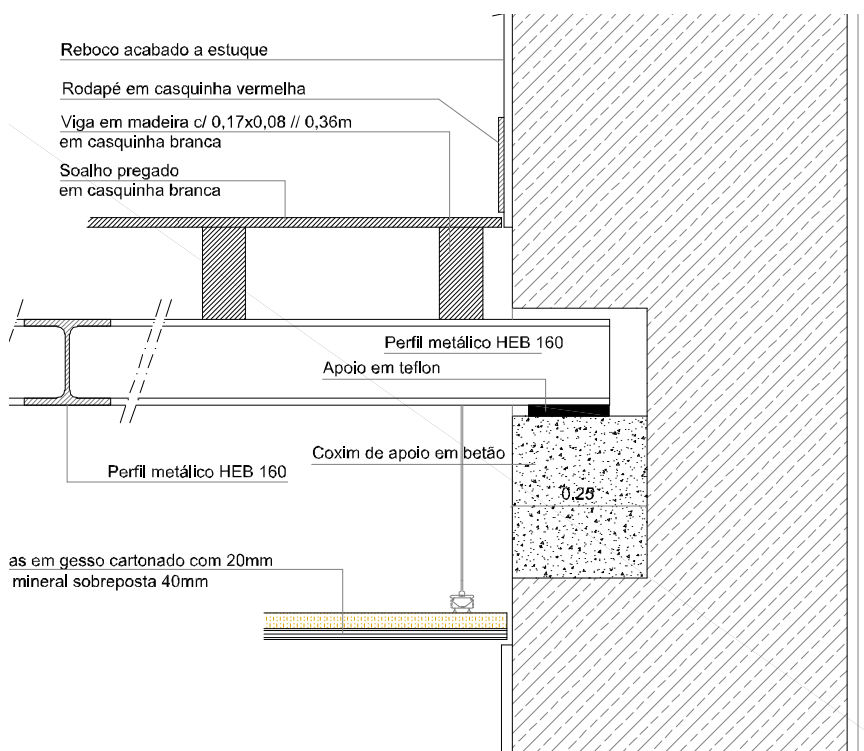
Pormenor de ligação Perfil HEB / Parede de alvenaria
